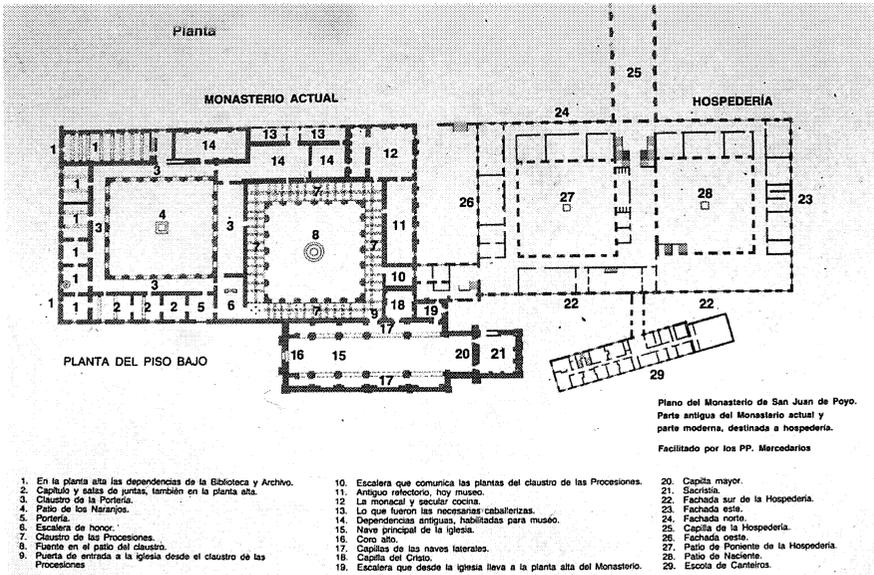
Monasterio de San Juan de Poio. Planta.
